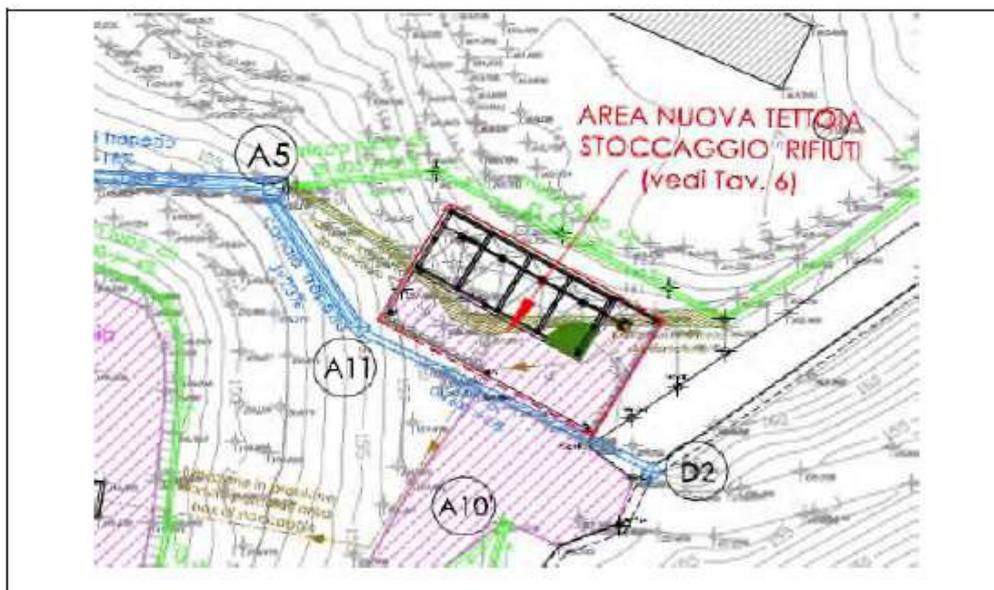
Ubicazione planimetrica della tettoia di stoccaggio dei rifiuti
